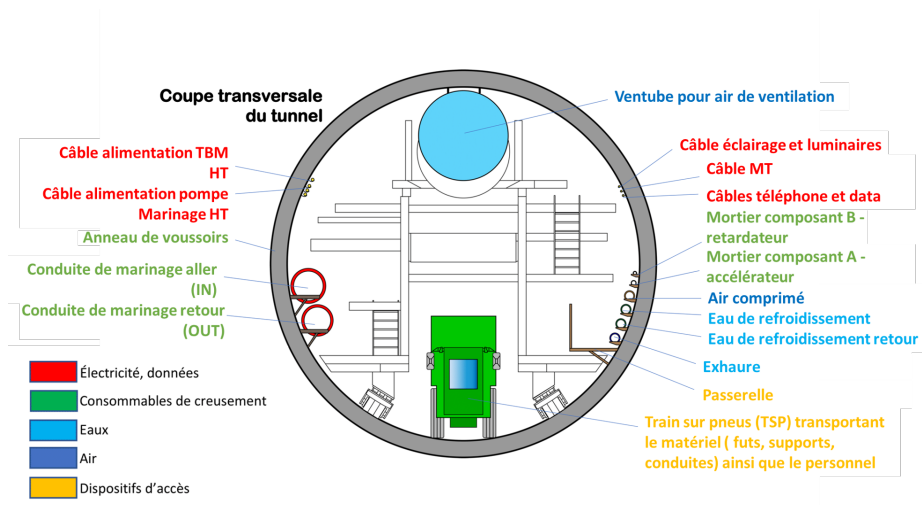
Coupe transversale du tunnel à l'arrière du tunnelier
